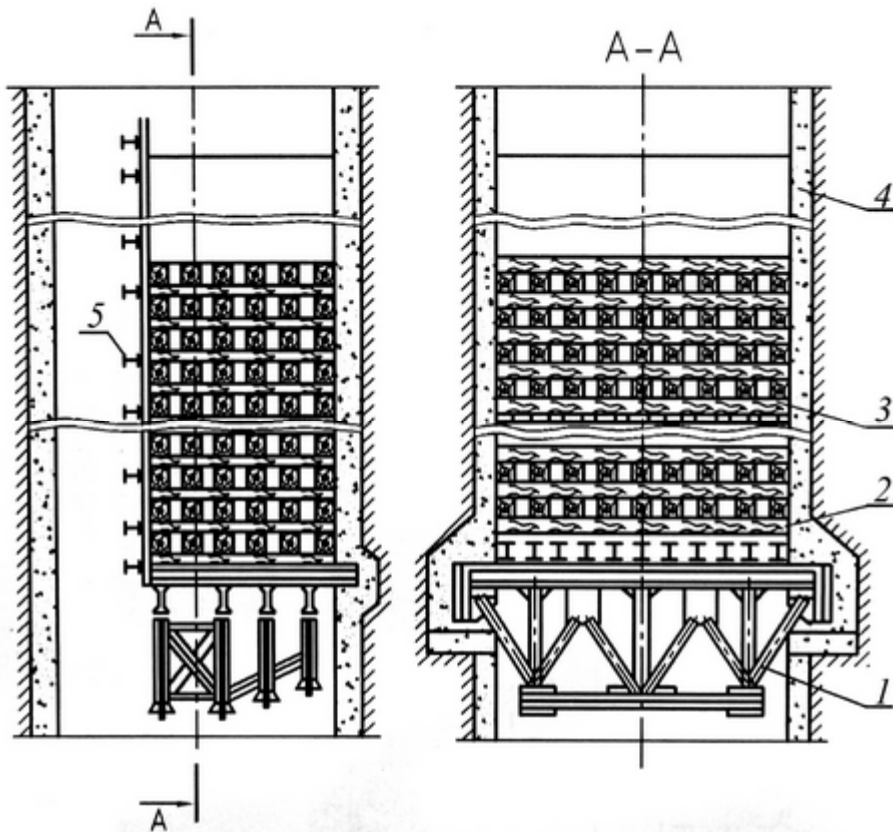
Предохранительный полук с ферменной несущей конструкцией:
